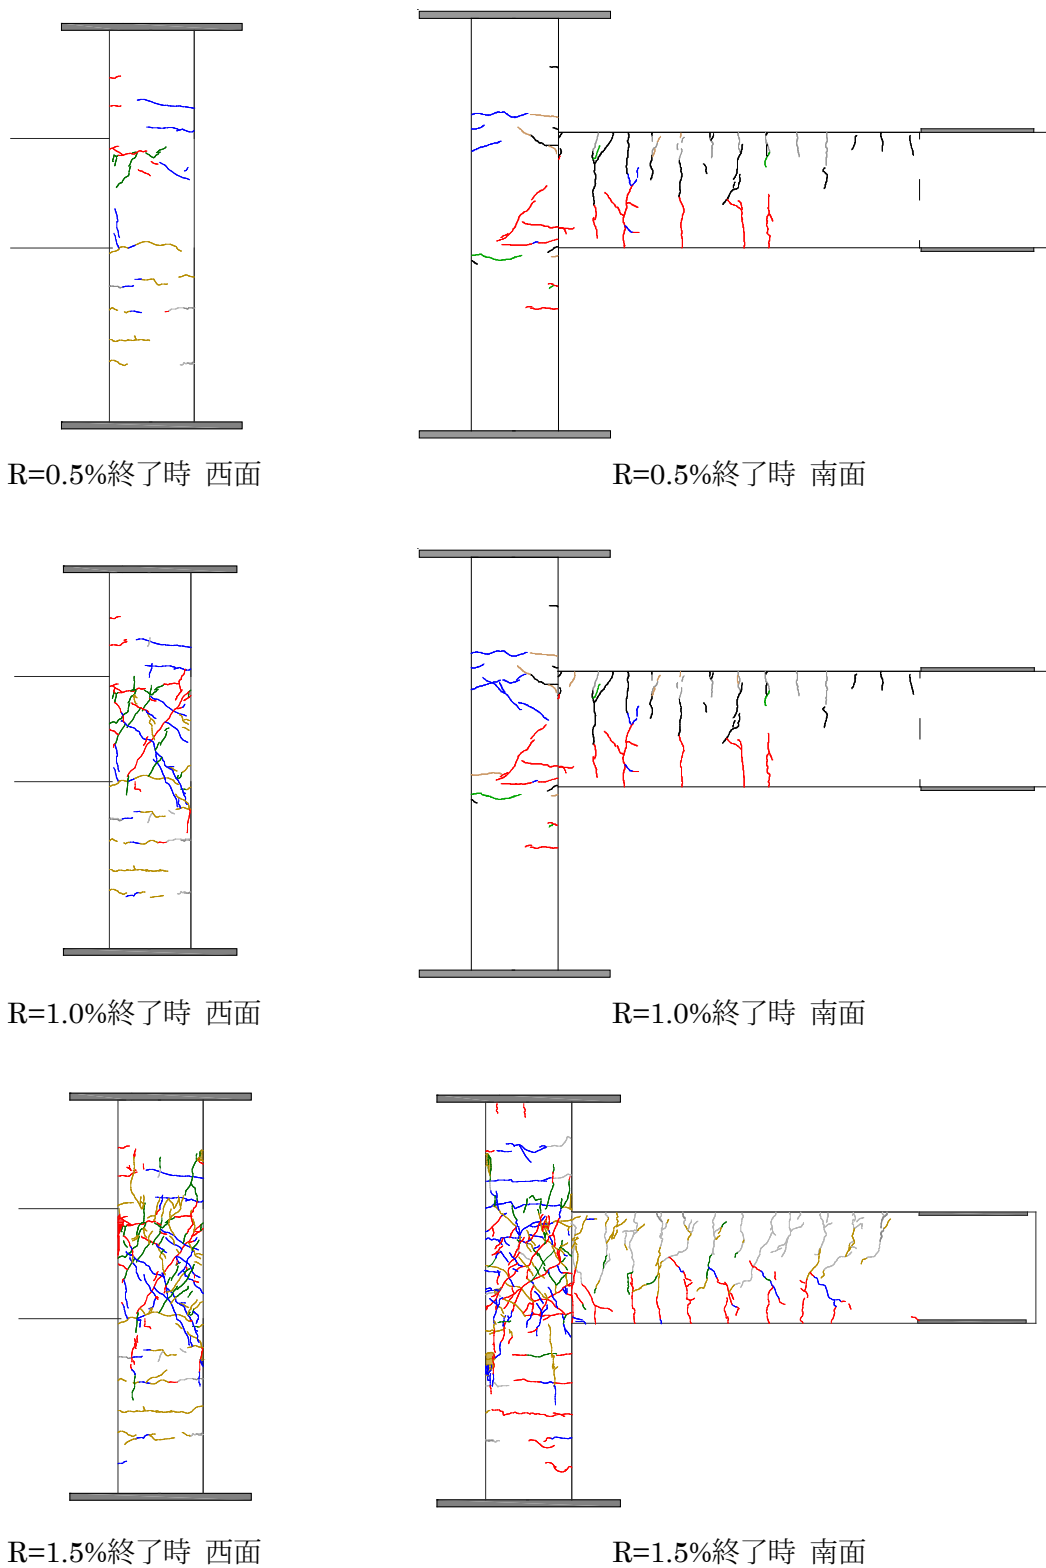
(c) ひび割れ状況 (試験体 F3)
